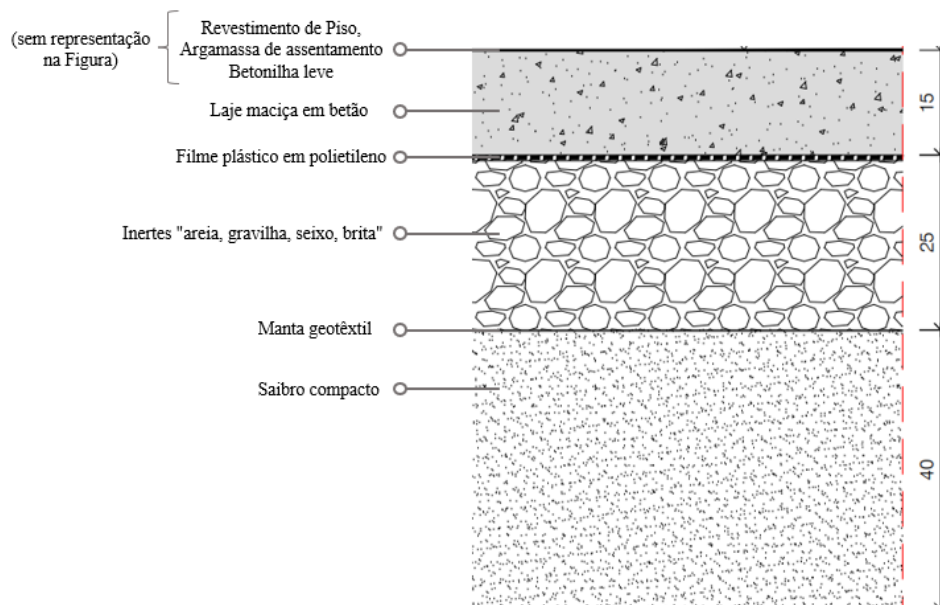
Pormenor construtivo do Pavimento Térreo PAVTER1.
